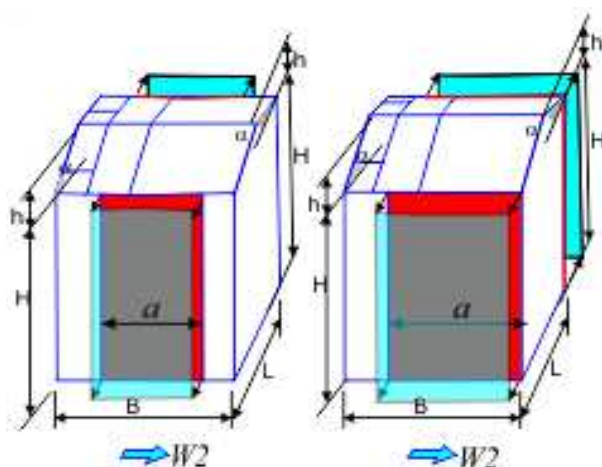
Схема приложения ветровой нагрузки на боковые стены
